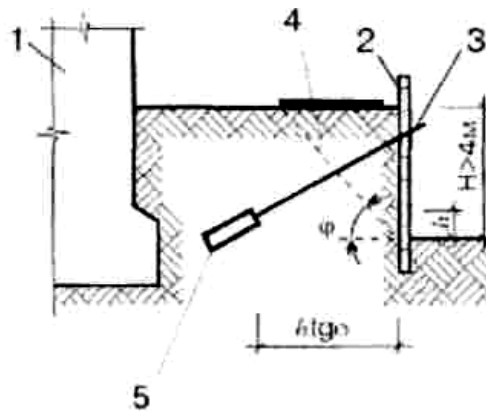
Схема анкерного кріплення: 1 – існуючі конструкції; 2 – захисна конструкція; 3 – анкерне кріплення; 4 – можлива призма обвалення; 5 – якорь
